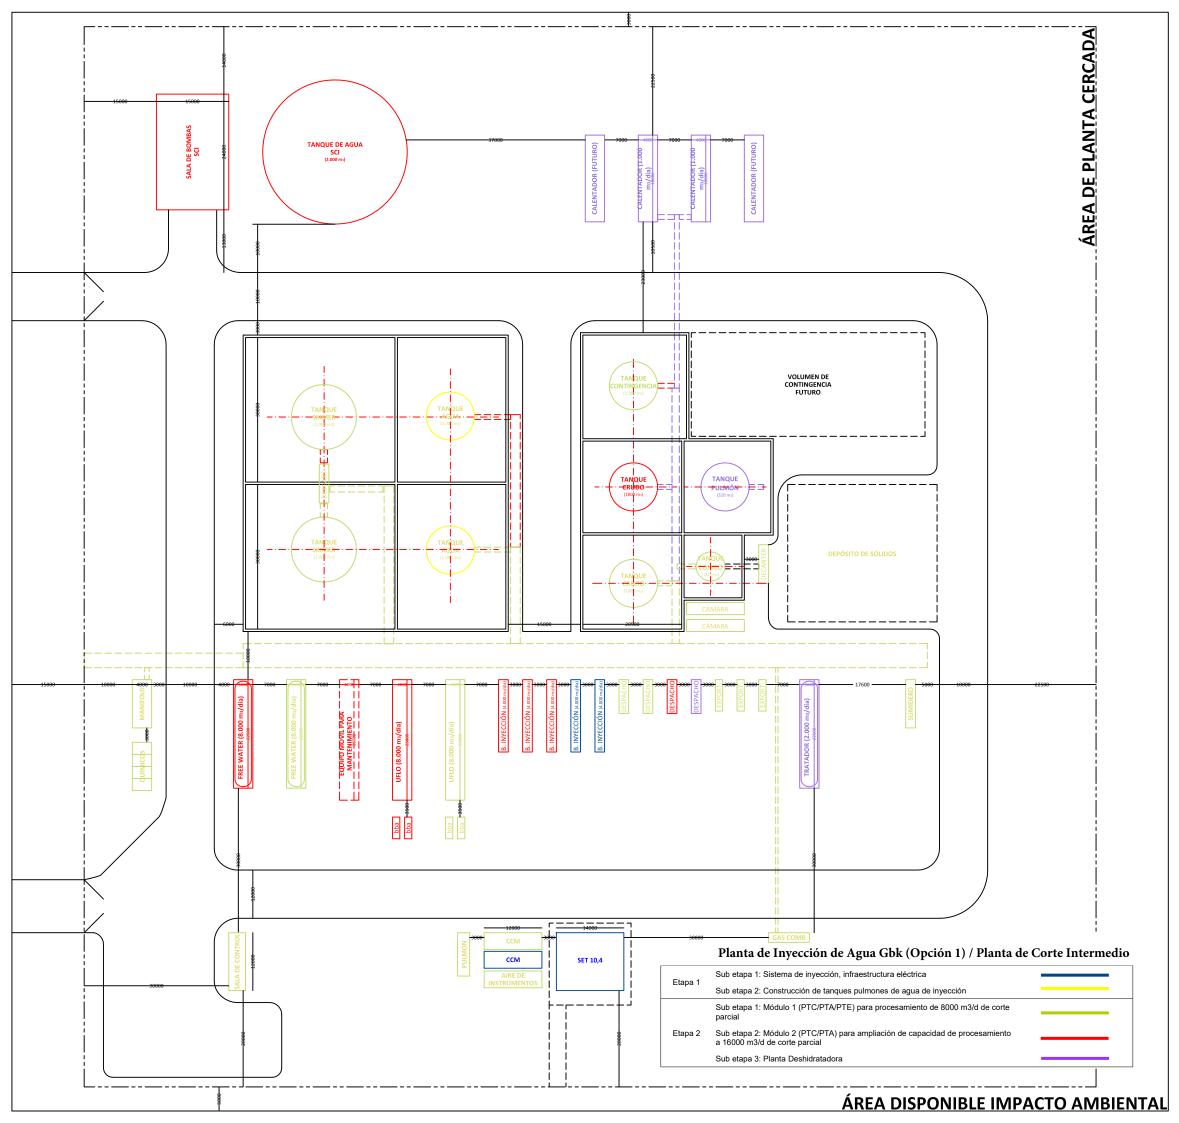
Alternativa de emplazamiento de Futura Planta de Inyección de Agua Grimbeek (Opción 1)
